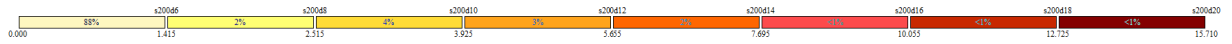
Площа арматури плити на 1 м. п. по осі y (верхня грань)
